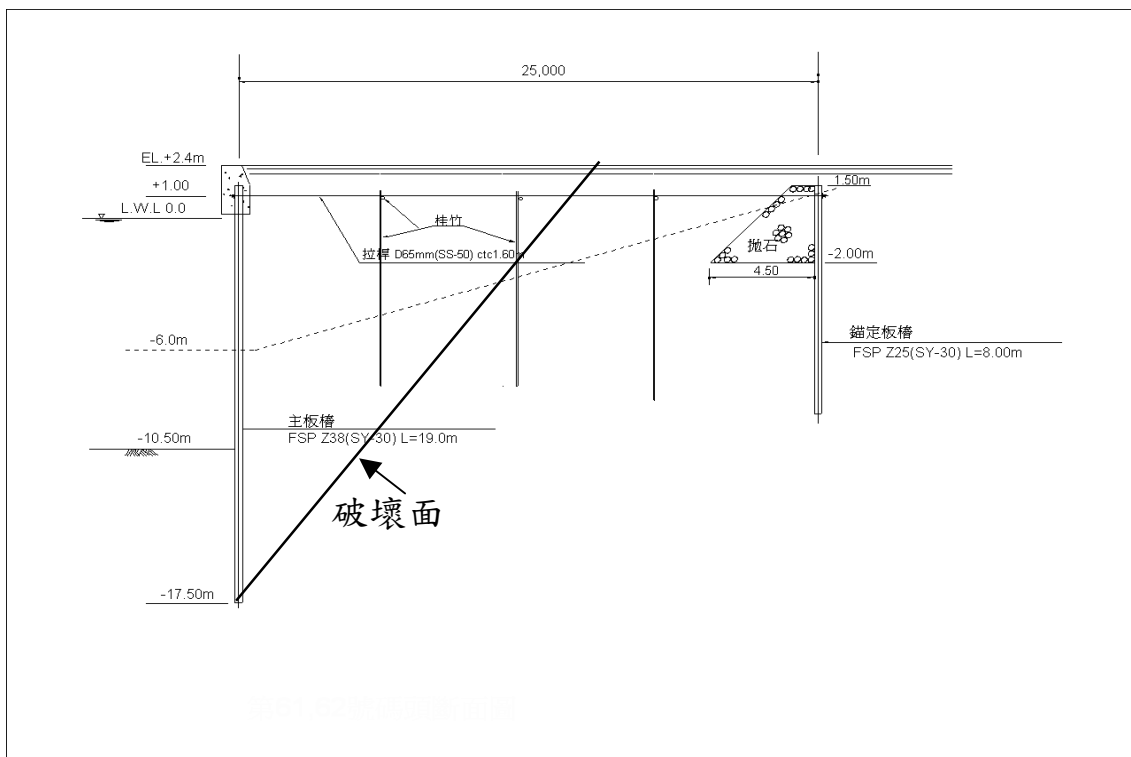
施工型板樁式碼頭主動破壞面示意圖
